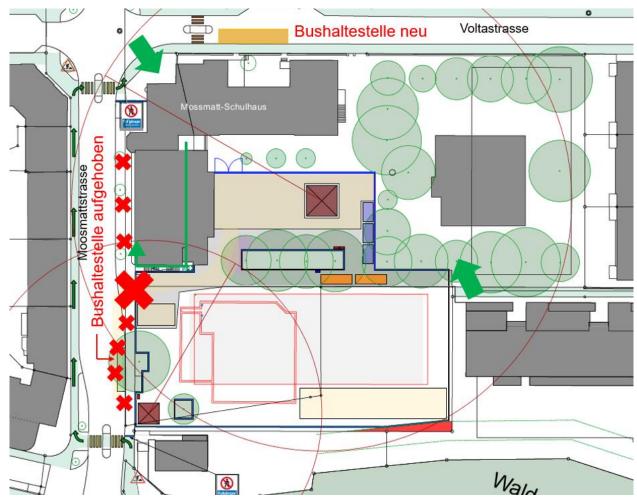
Baustelleninstallation, Arealzugänge und Pausenplatz ab Dezember 2024
